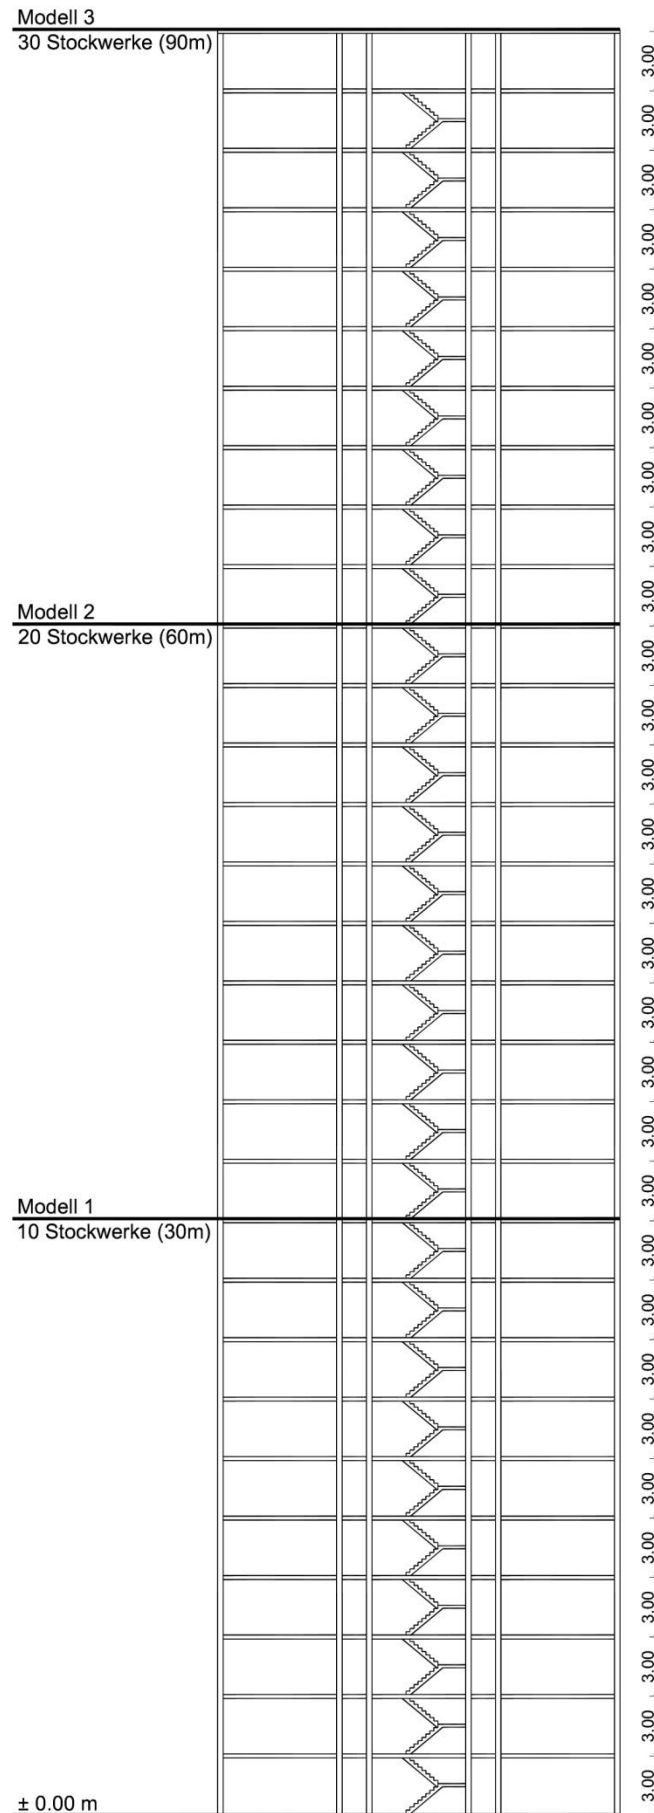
Prinzip-Schnitt mit Kennzeichnung der Modellhöhen
